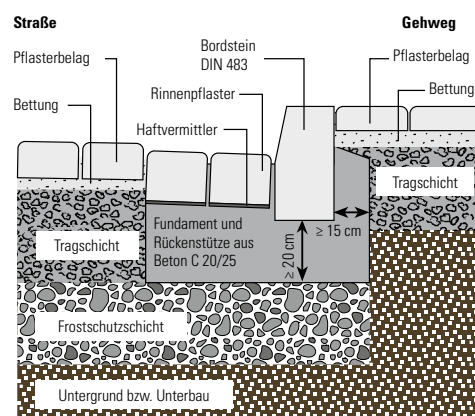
Einbaubeispiel für eine Randbefassung mit einem Hochbordstein aus Beton und Entwässerungsrinne
